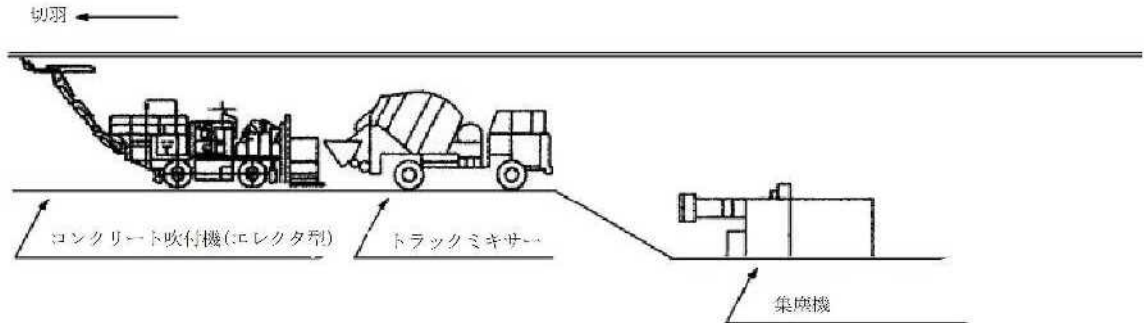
吹付コンクリート施工機械配置例(参考図)
